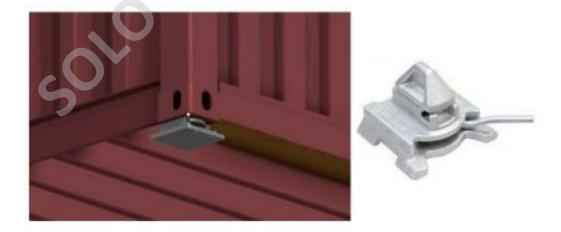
Sistema de anclaje twistlock. Fuente: HEDD ENGINEERED DESING, 2016.
